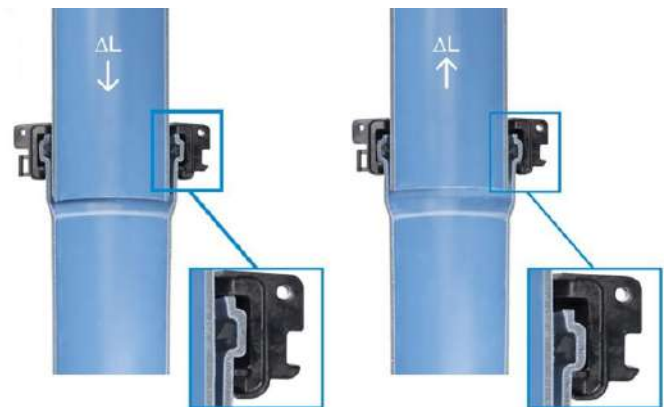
Vista de sección de instalación de la abrazadera/collar antideslizamiento.
